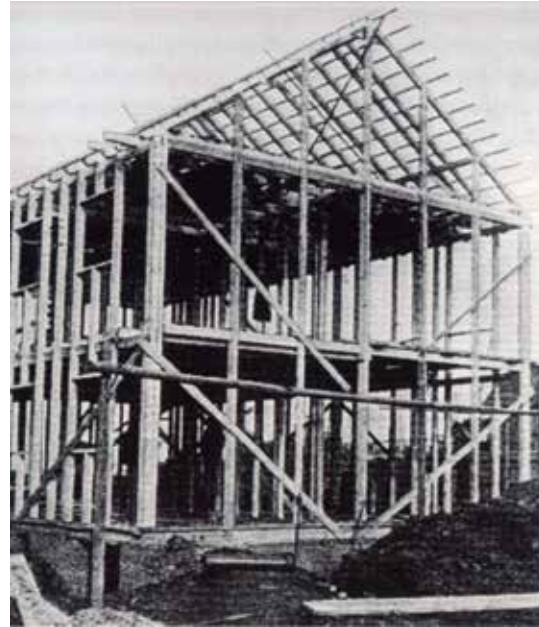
Sistema combinado, vivienda No. 9, bajo construcción, 1933.
